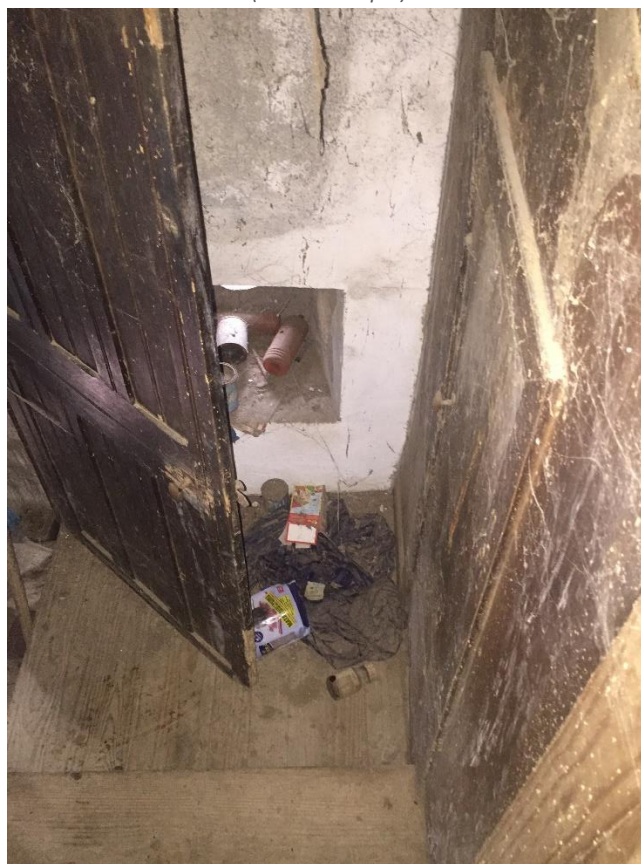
Vista interior del hueco en fachada circular y de la puerta al aseo. (Fuente: Propia)
